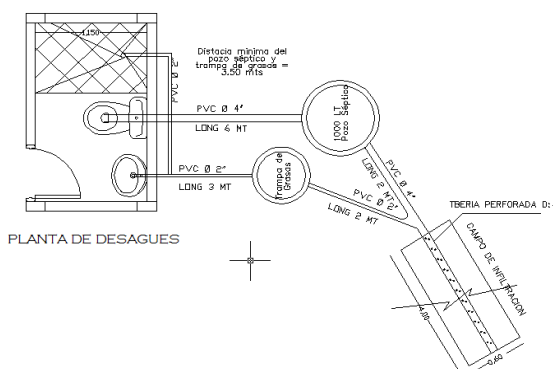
Tubería de diámetro Ø = 2”, Ø = 3”; y esquema en planta del sistema séptico.
